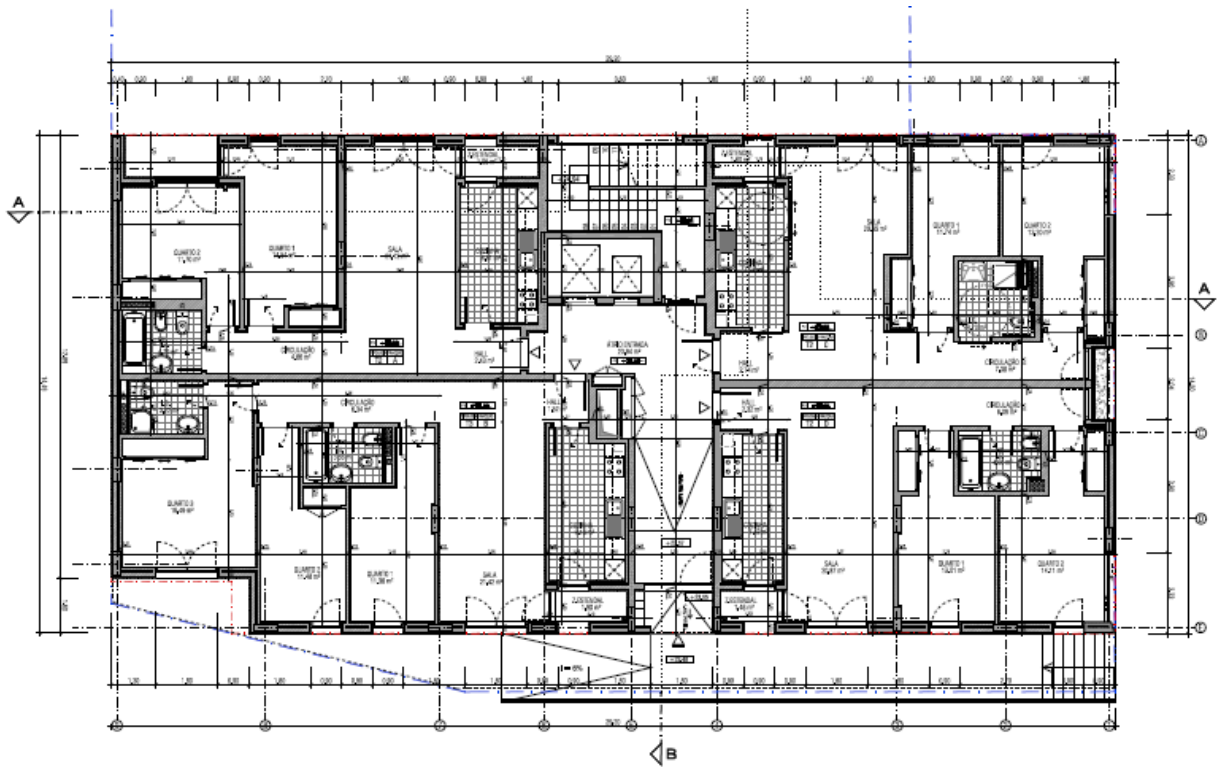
Lote 1, 2, 3 e 4 planta do piso tipo (piso 1 a 5)
